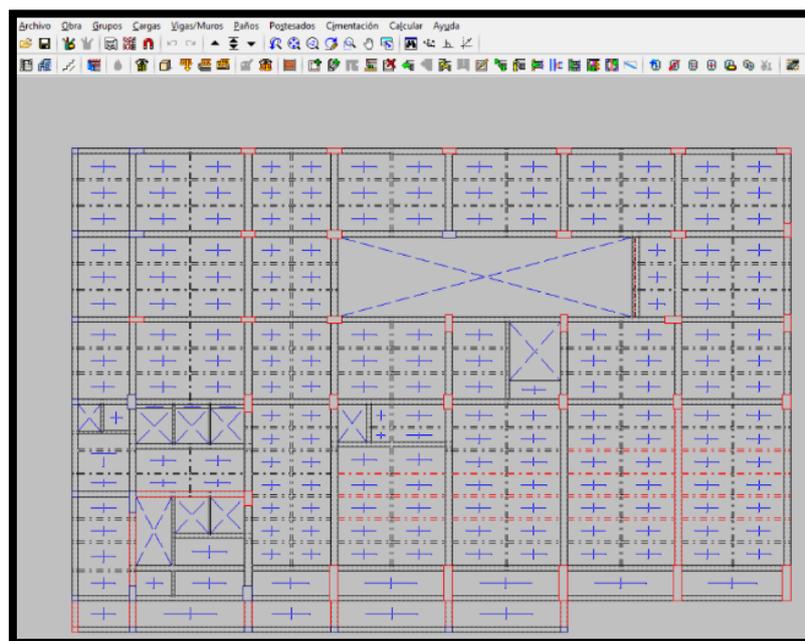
Vista en planta VITRO (CYPE Ingenieros, 2018)
